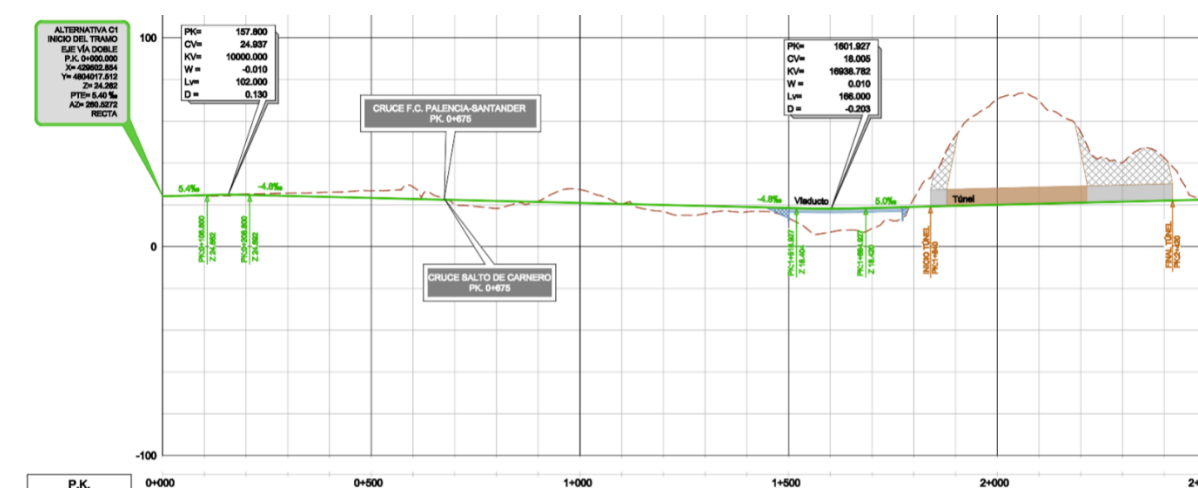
Perfil longitudinal Alternativa C1 rasante baja. Salto de carnero
